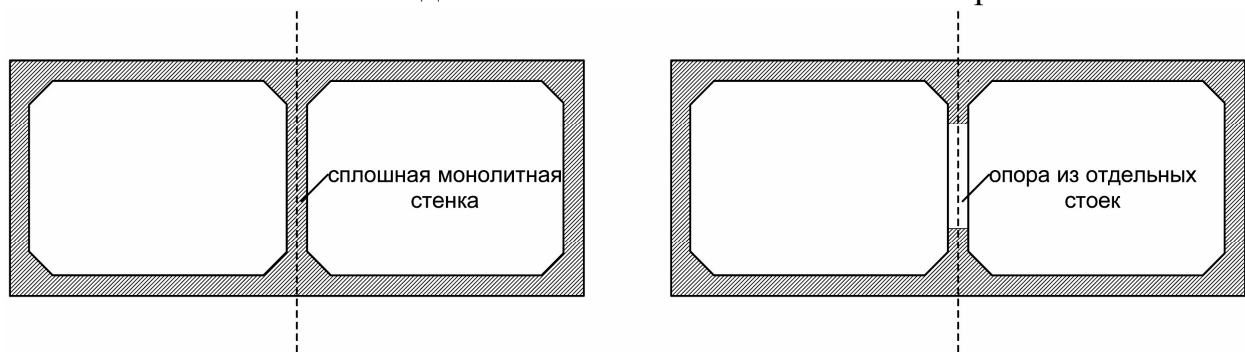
Поперечное сечение монолитных конструкций тоннелей:
